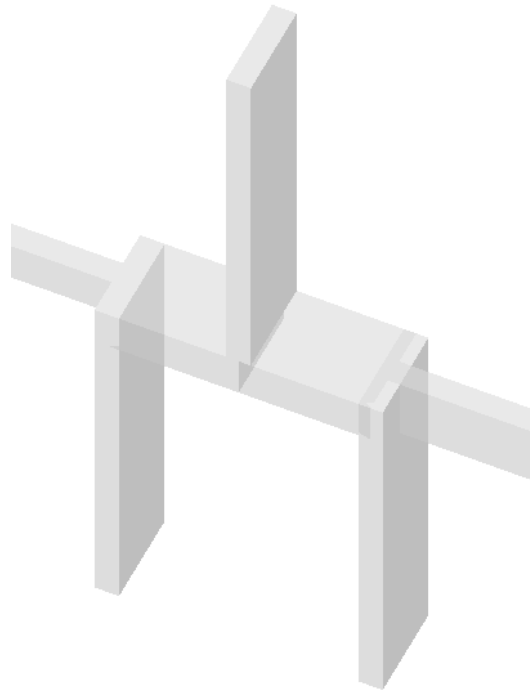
Pormenor do pilar que arranca do meio de uma viga
